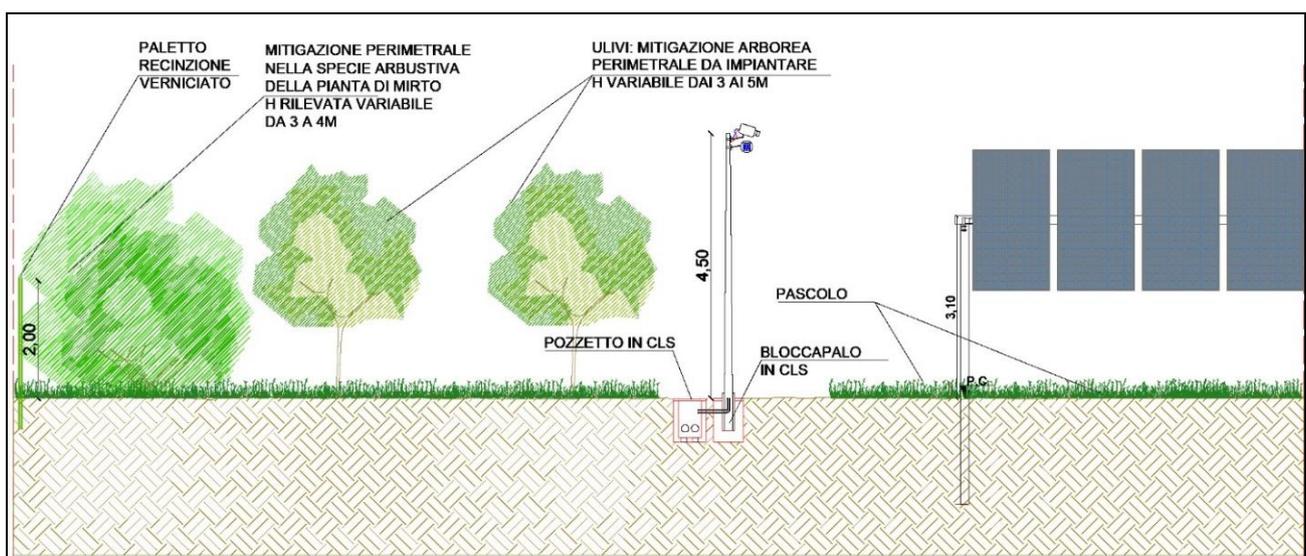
Dettaglio recinzione e mitigazione perimetrale
